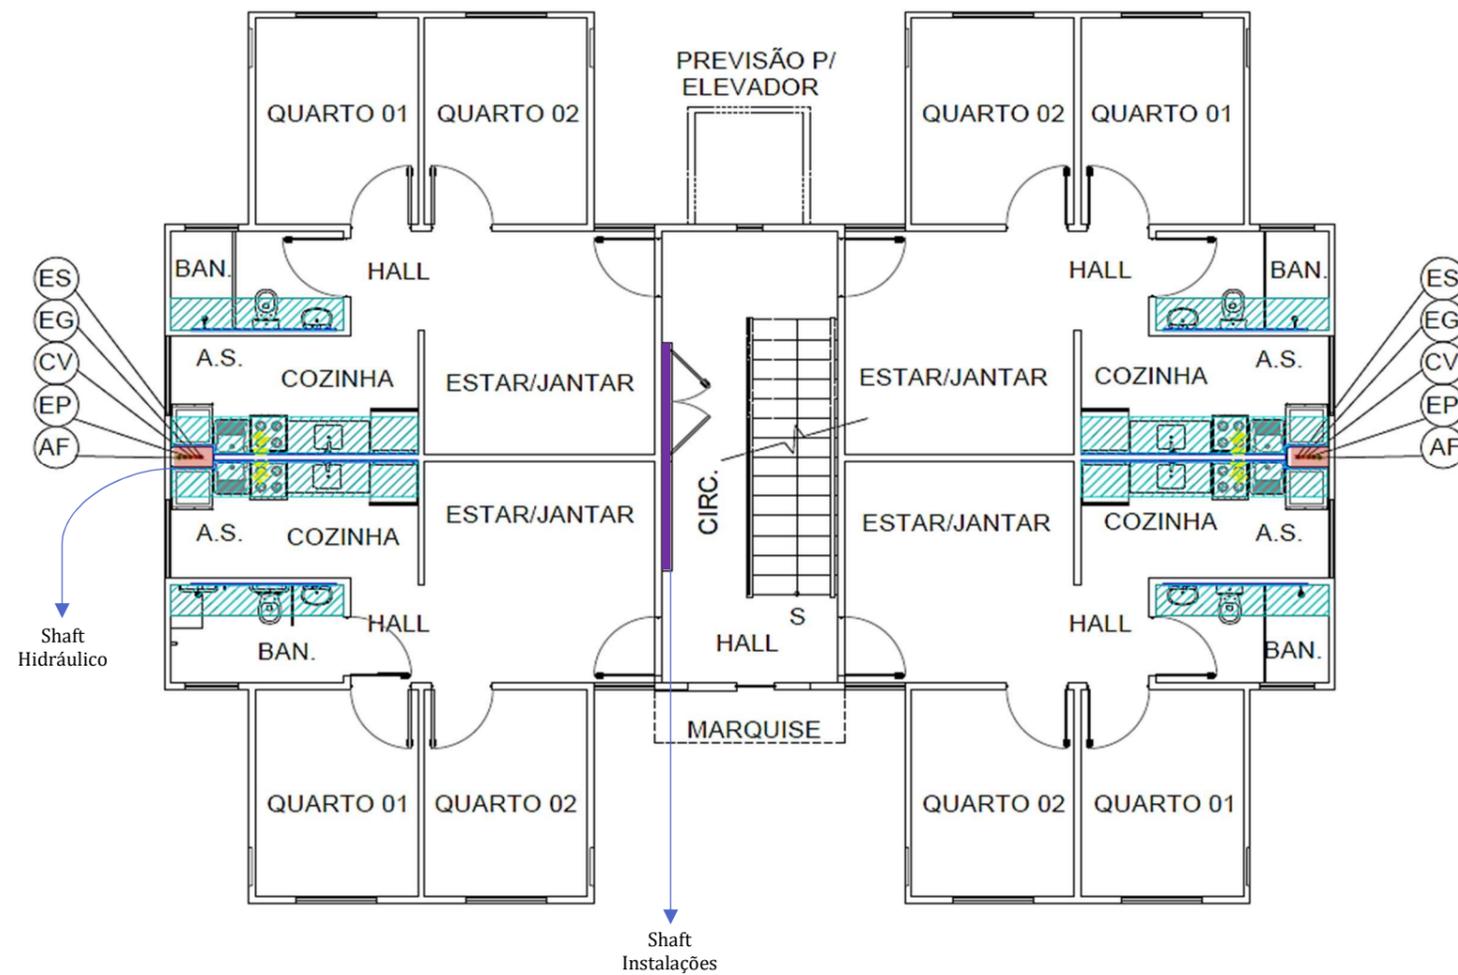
Instalações hidrossanitárias - Pavimento tipo. Sem/Esc.
